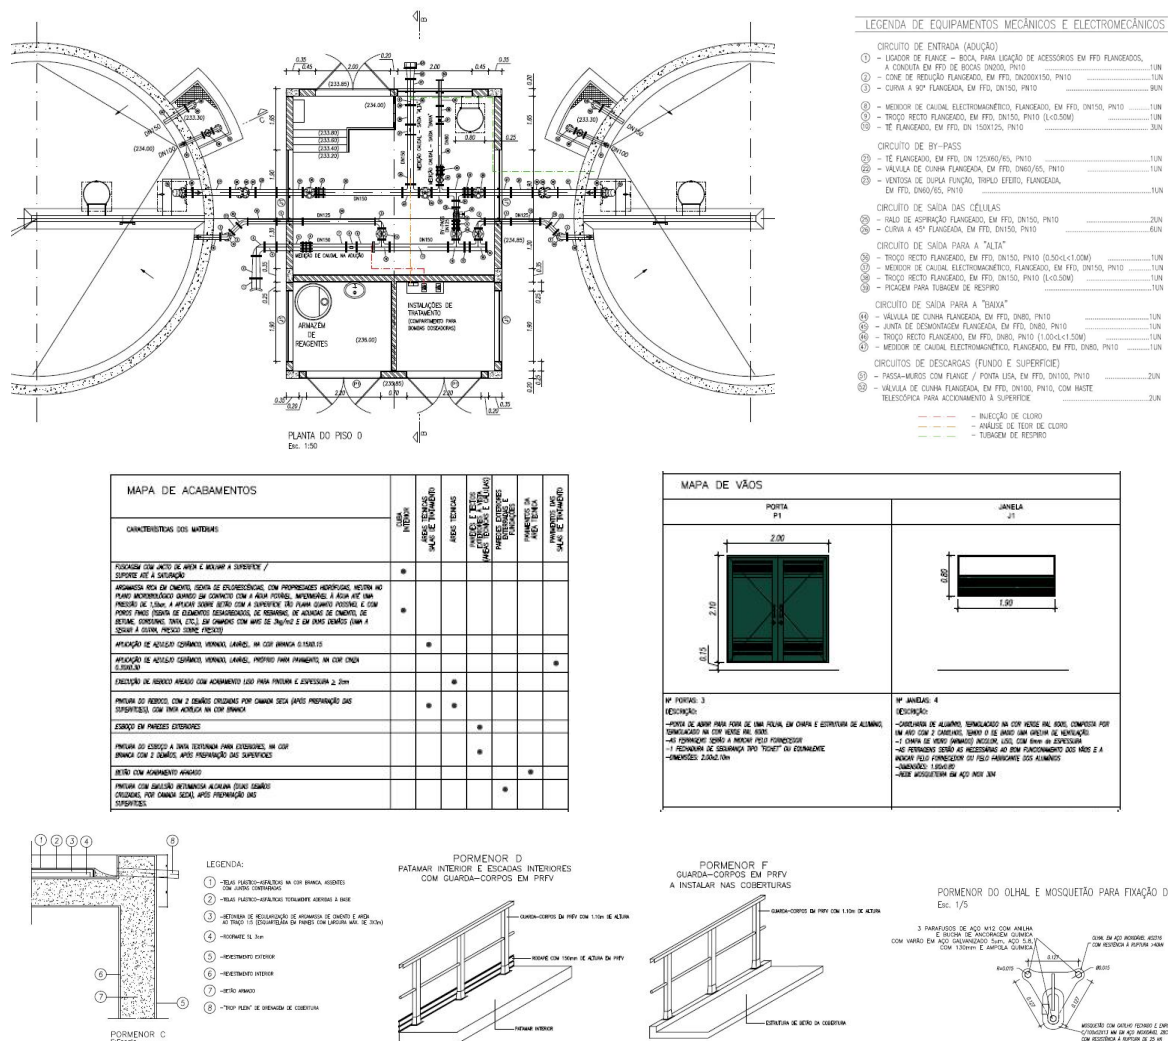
Exemplos de Pormenorização para Projeto de Execução (Fonte: FASE)
